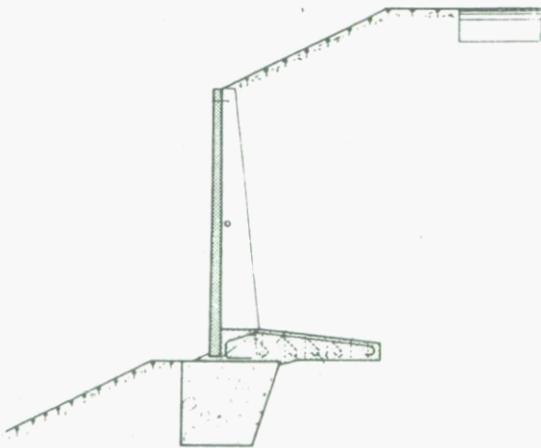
Muro de pantalla prefabricado y zapata "in situ" (TENSITER)
